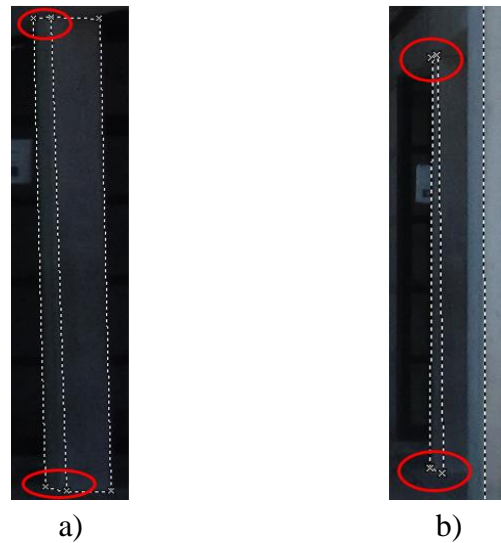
Pontos com baixo ângulo de separação entre si: a) foto B e b) foto C do mesmo pilar
